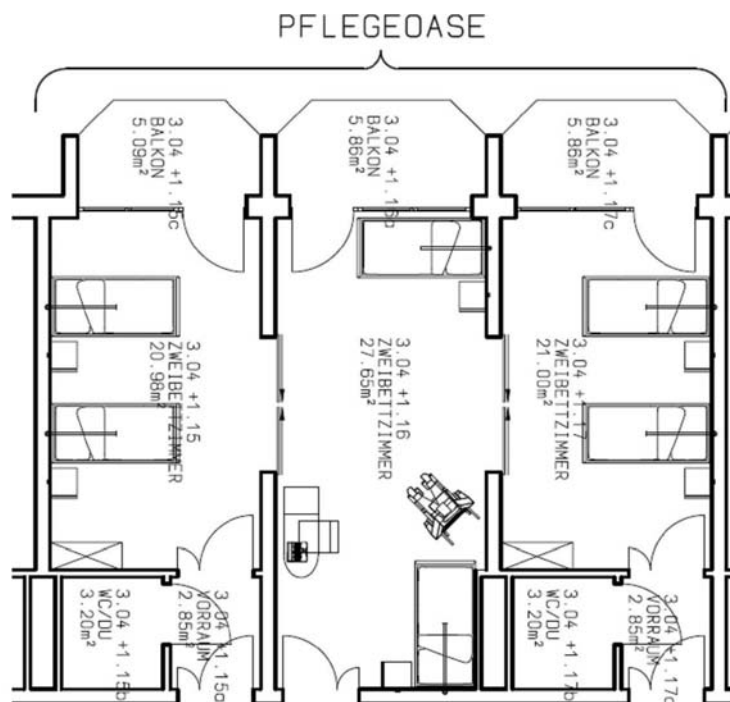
Grundriss Pflegeoase Wiesengrund W3. Das Bett im mittleren Zimmer am Balkon wurde nicht aufgestellt. Stattdessen ist hier der Gemeinschaftsbereich
